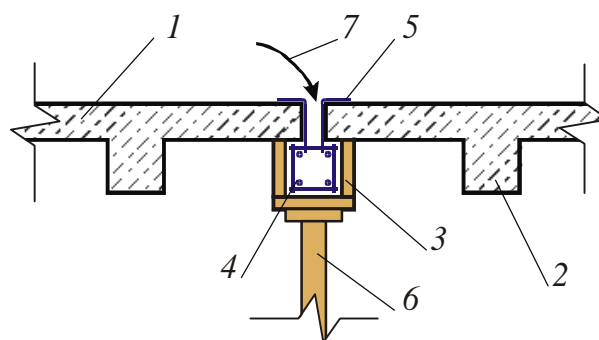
Усиление монолитного железобетонного перекрытия:
